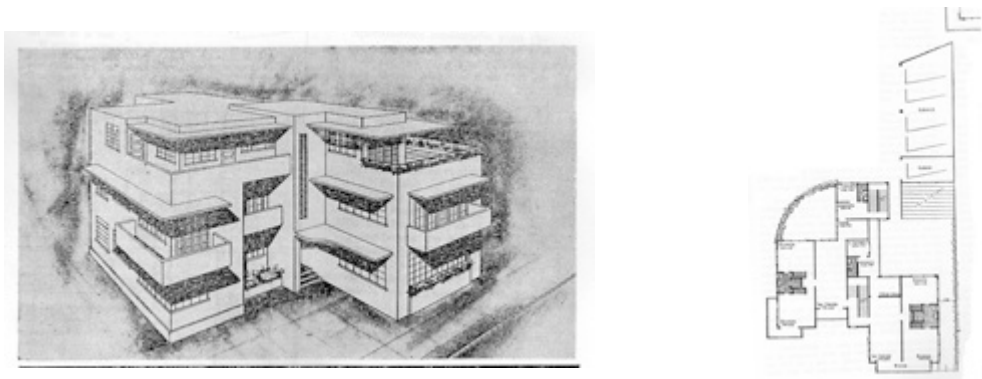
Edificio para Club de Leones. Arq. Cesar Terrientes – Panamá 1949. Fuente: Revista Ingeniería y Arquitectura Panamá
